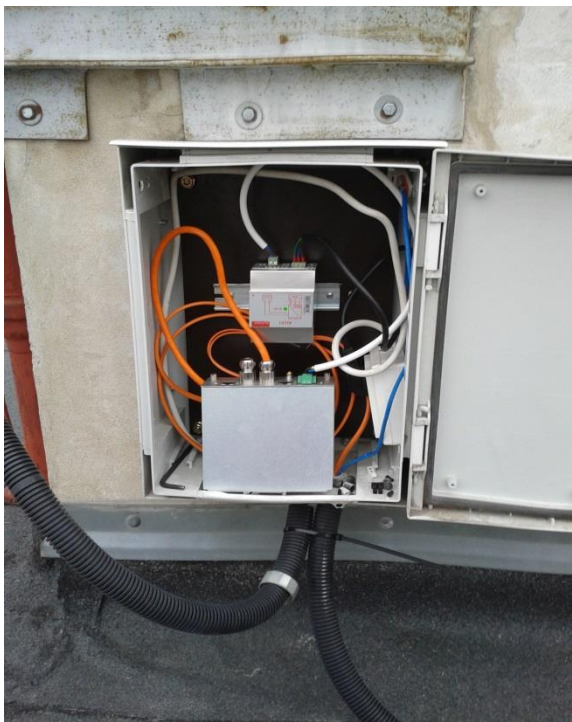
Lokalita Šrobárova – montáž IDU
